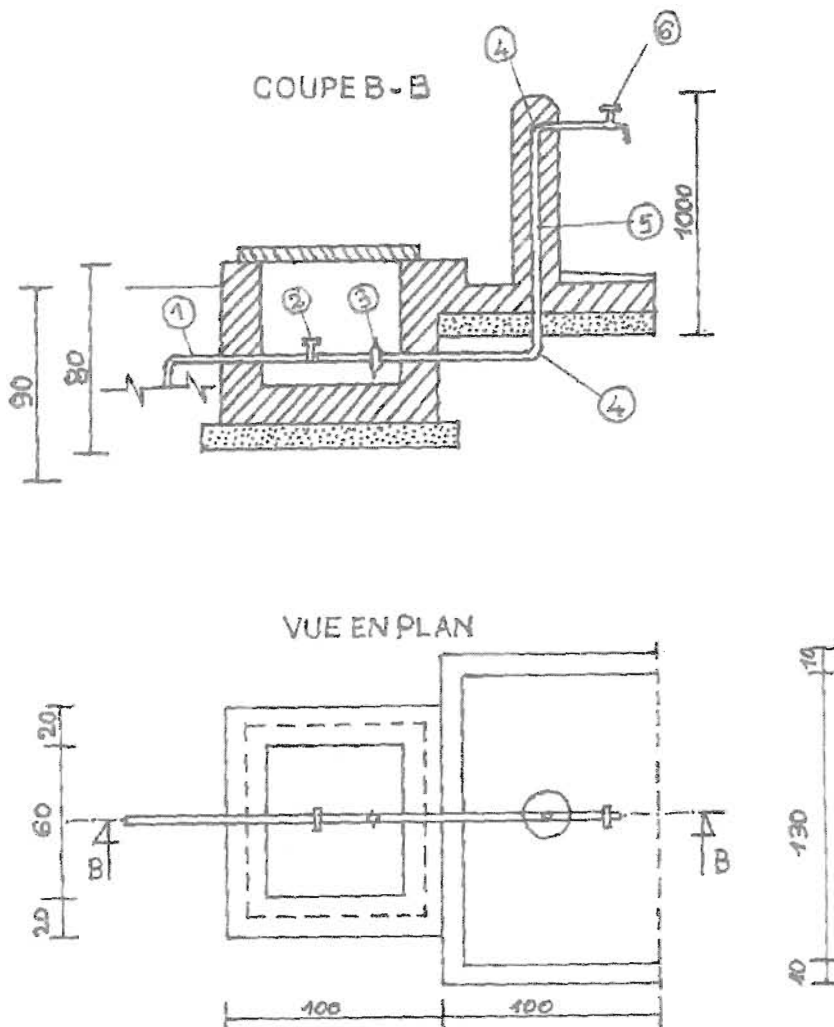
Vue en plan et coupe d'une borne fontaine.
